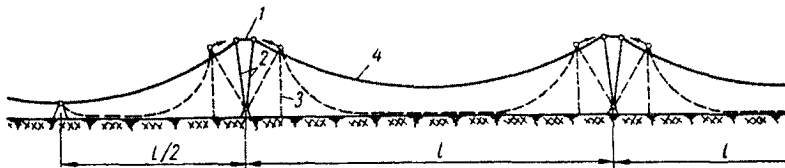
Монтаж трубопроводу з П-подібними опорами на лінійних ділянках: 1 – затяжка; 2 – рама; 3 – тимчасова опора; 4 – трубопровід
